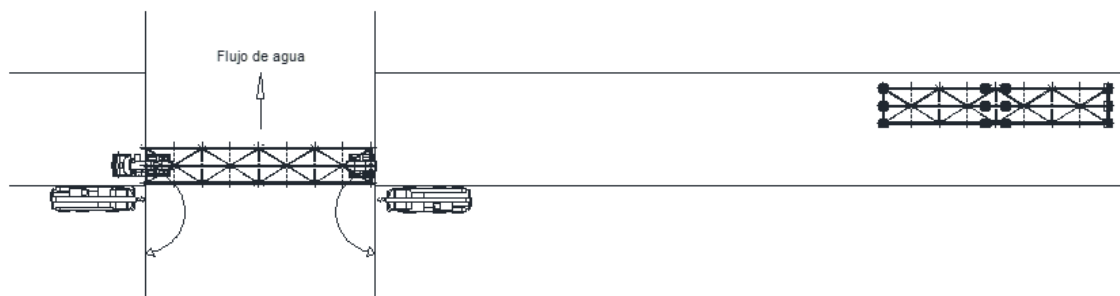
Dolly con las vigas metálicas sobre el puente existente
